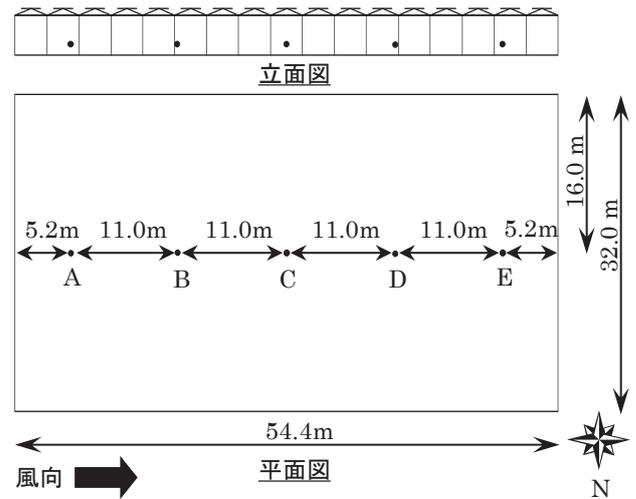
17連棟のフェンロー型温室の平面・立面図および測定点(●)の配置
